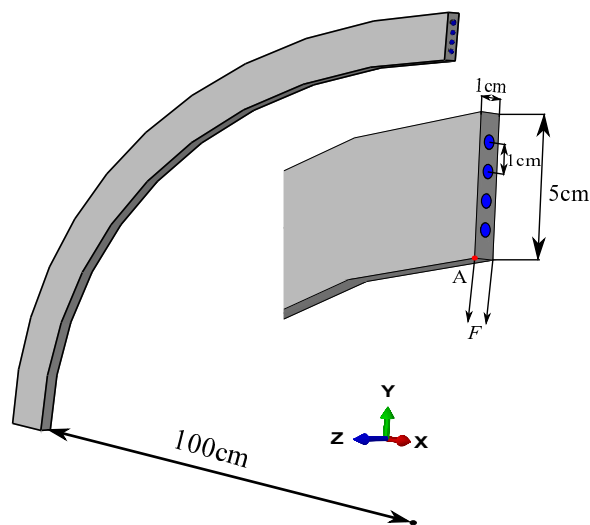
Poutre circulaire 3D en béton renforcé par quatre barres en acier.
